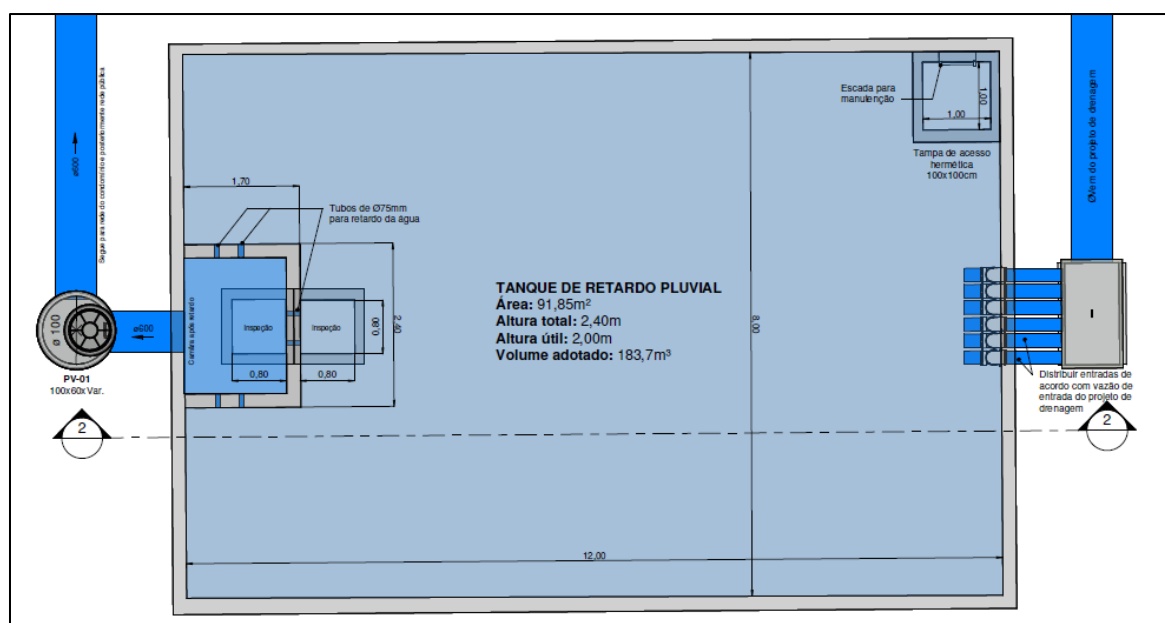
Sistema de retardo pluvial em planta. Imagem retirada da prancha do projeto.
